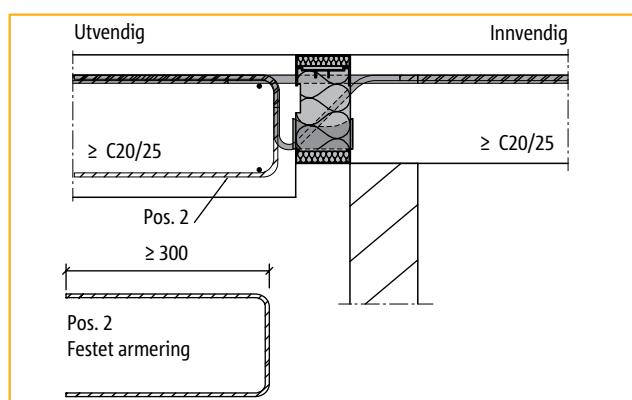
Schöck Isokorb® type K, ekstra armering Pos. 1
